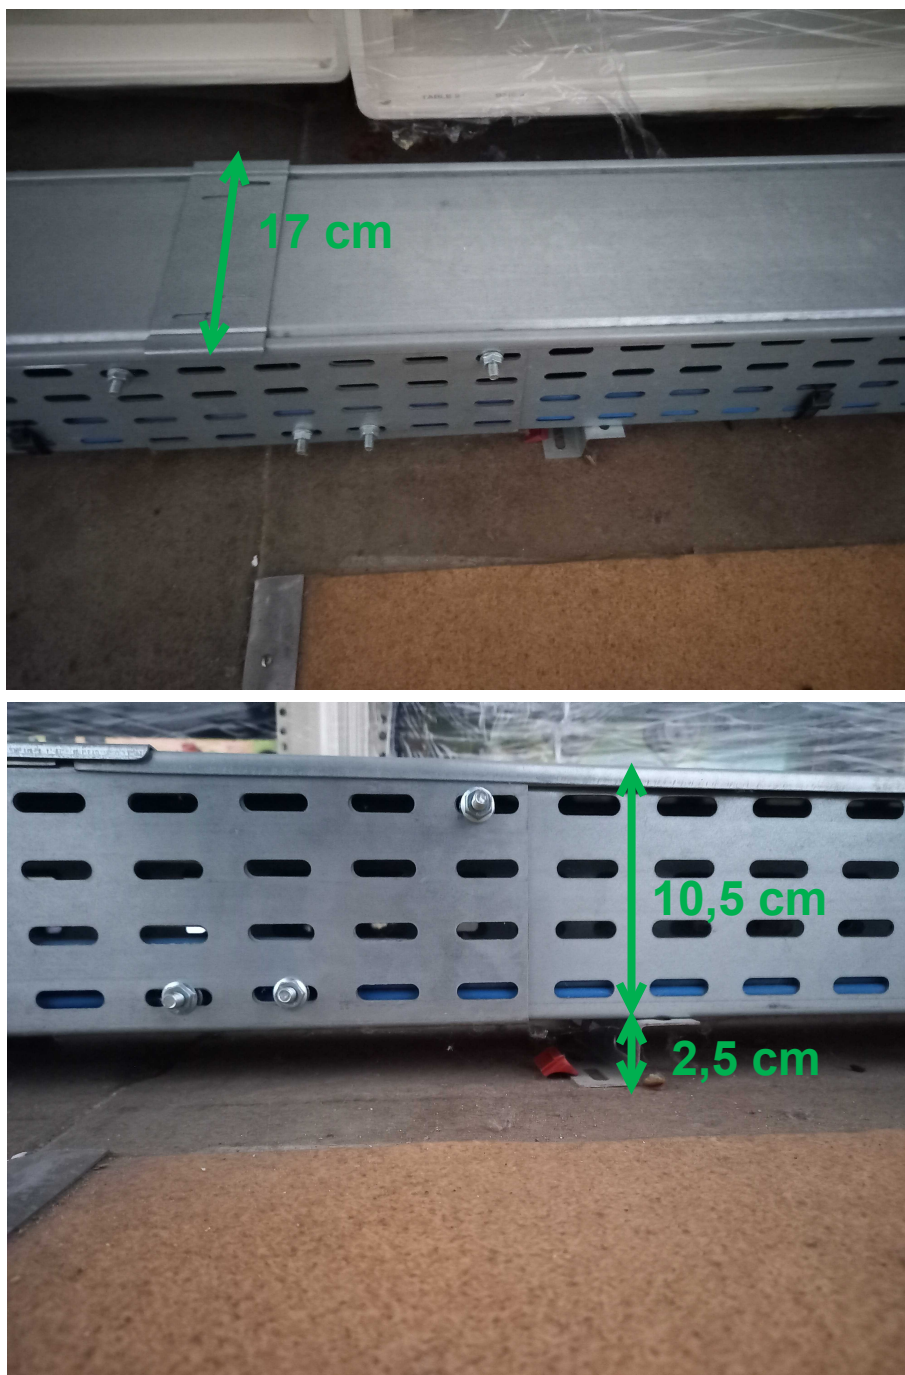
Photos et dimensions du passage de câbles traversant le hall entre les salles CALVA-1 et CALVA-2
